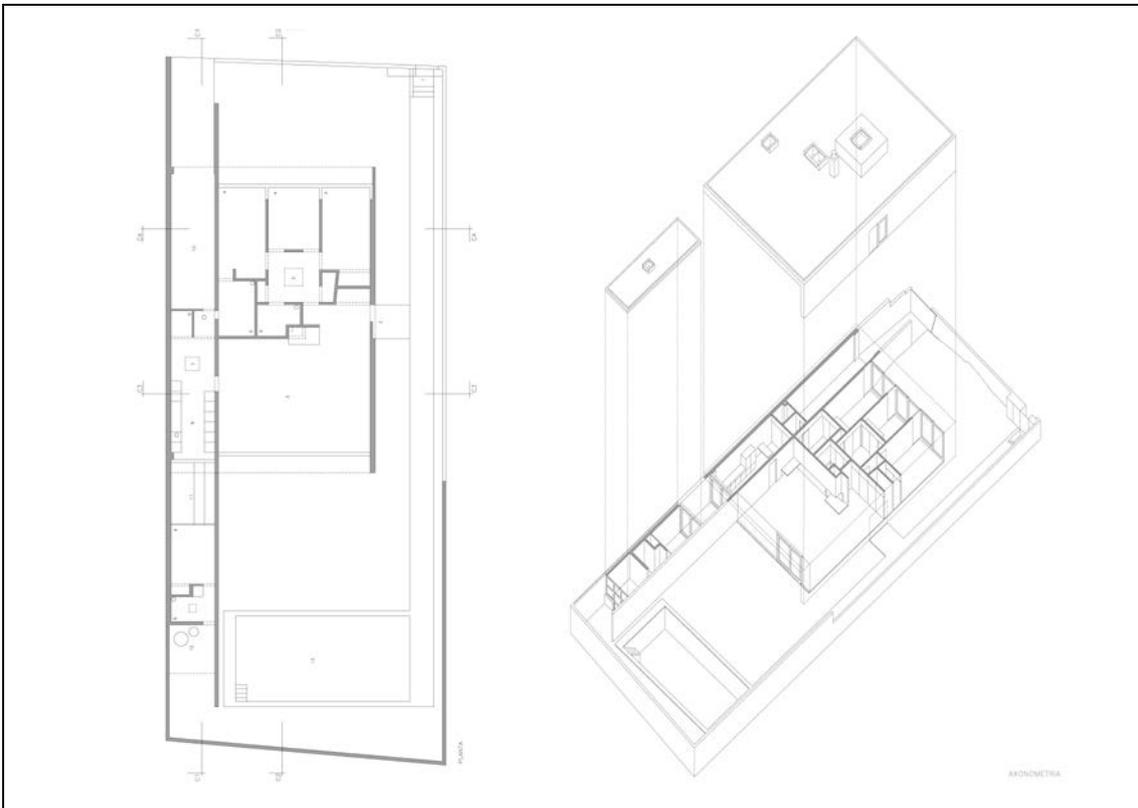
Planta e axonometria da Casa de Nevogilde I
